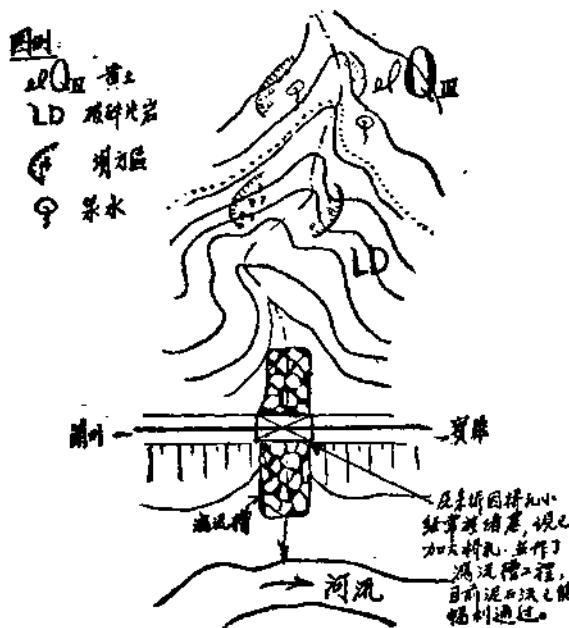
宝蘭綫K 1324 (凤閣嶺) 加大桥孔与修筑泻流槽工程平面示意图
